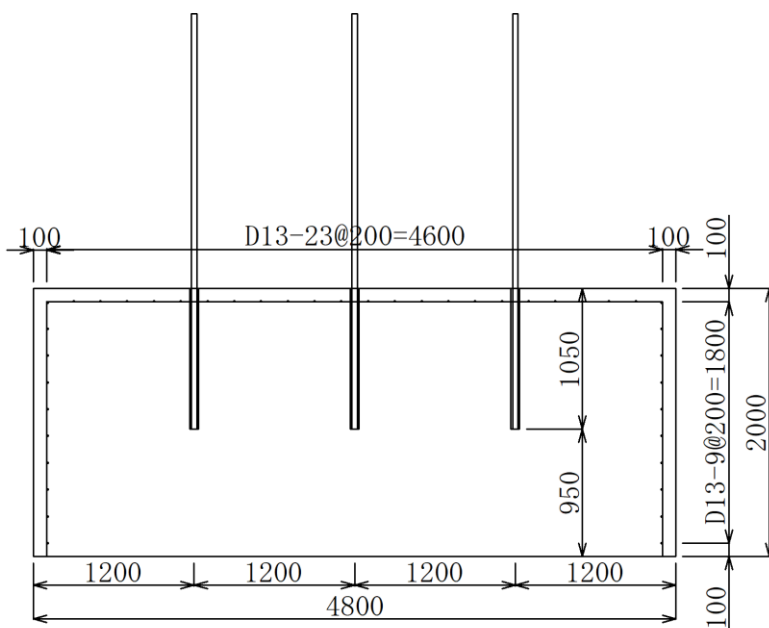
(4) 実験体①の配筋図 (C-C 断面図)
